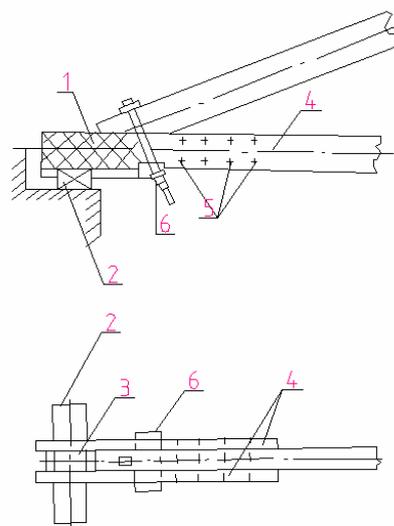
Усиление опорного узла висячих стропил при сгнившем конце затяжки и подкладки: 1 – зона загнивания; 2 – вновь укладываемая подкладка; 3 – вкладыш сечением 100×150 мм; 4 – накладки; 5 – гвозди; 6 – болт
